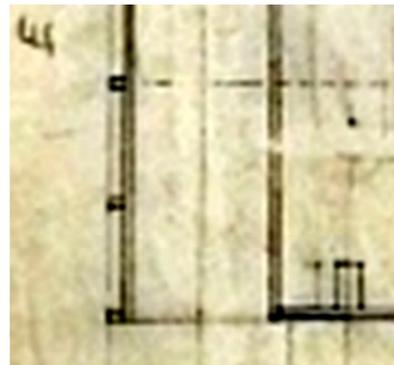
FLC 29875: Ampliado y contrastado de la fachada principal con detalle de recubrimiento por exterior de pilares de las fachadas laterales.
